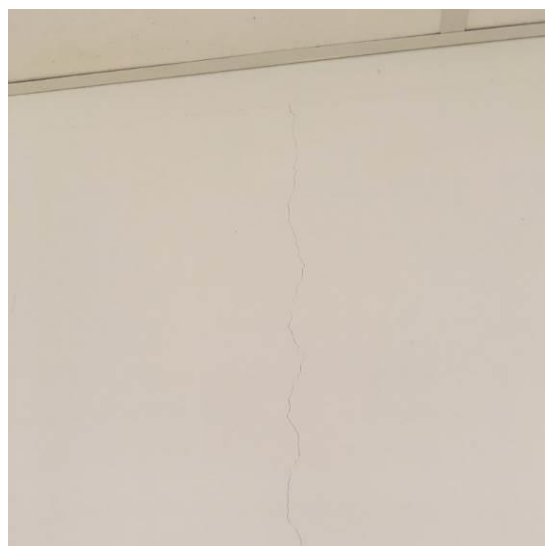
Bâtiment B RDC, salle 8 - Paroi verticale : D2 – Fissuration modérée.
